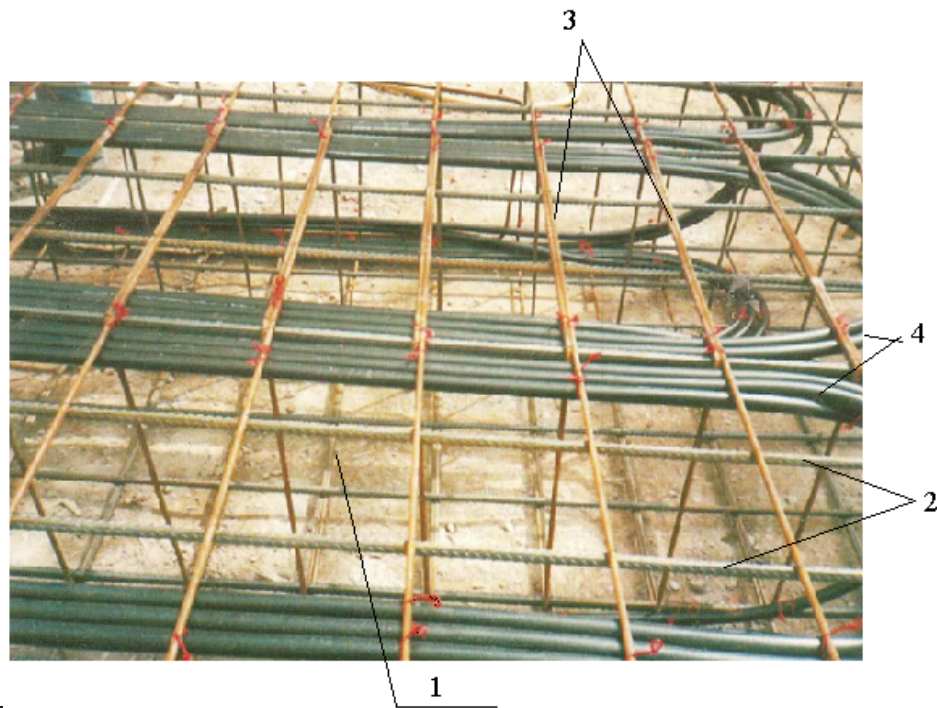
Варіант прокладки колектора теплового насоса в тілі плитного фундаменту: 1 – просторовий арматурний каркас; 2 і 3 – поздовжня і поперечна арматура; 4 – пластикові труби колектора теплового насоса
